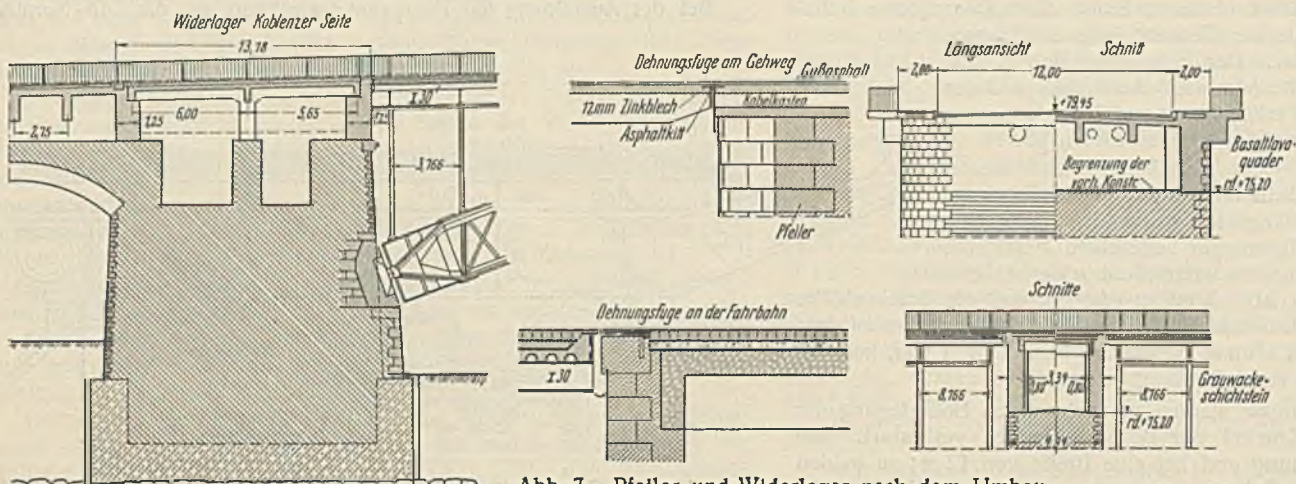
Pfeiler und Widerlager nach dem Umbau.
